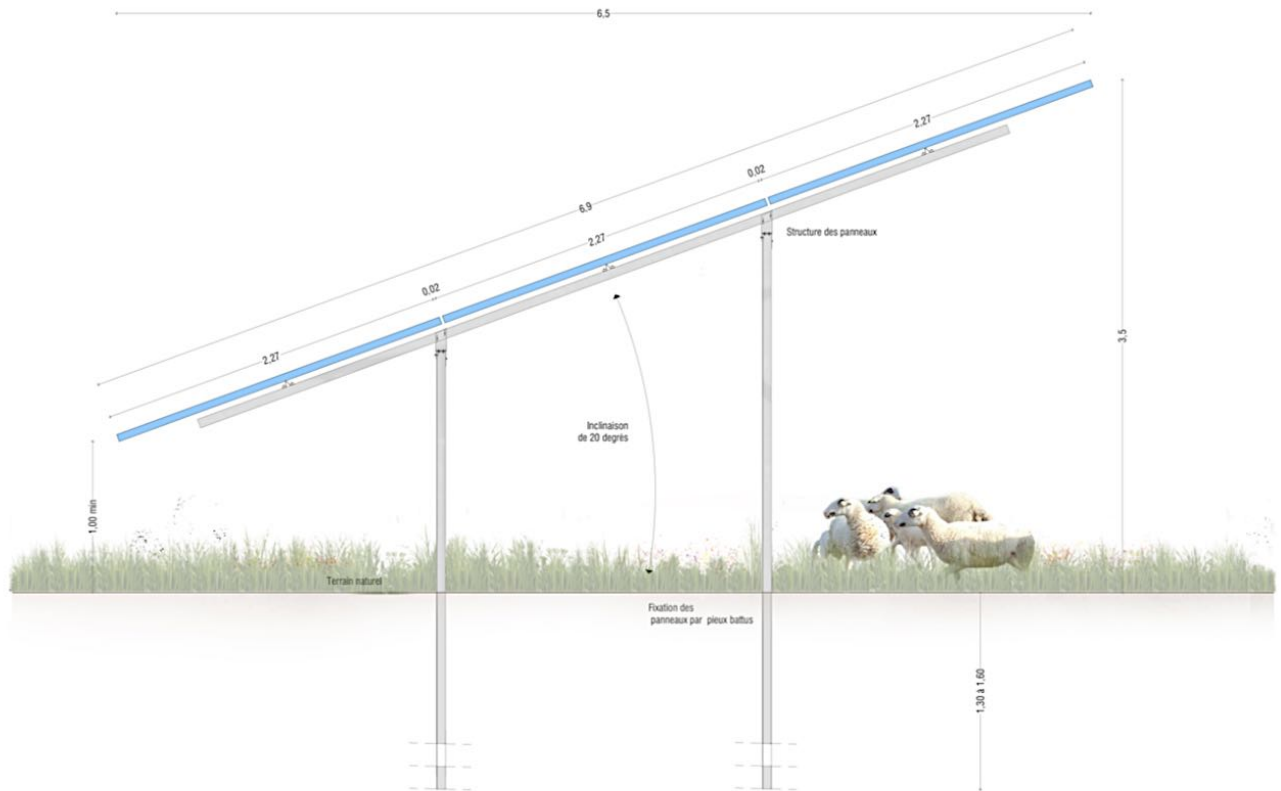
Coupe latérale d'une rangée de panneaux. (Source : PHOTOSOL)
